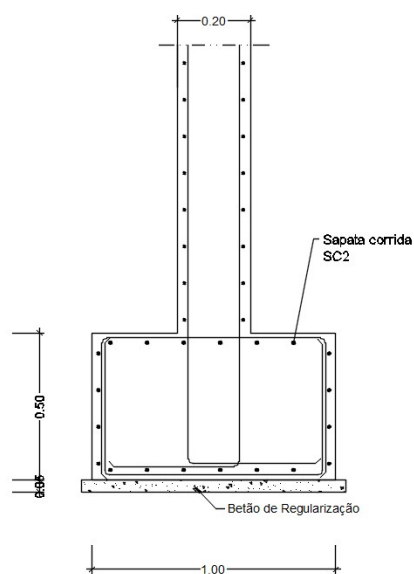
Corte transversal do muro de suporte de terras em análise (sem escala).
